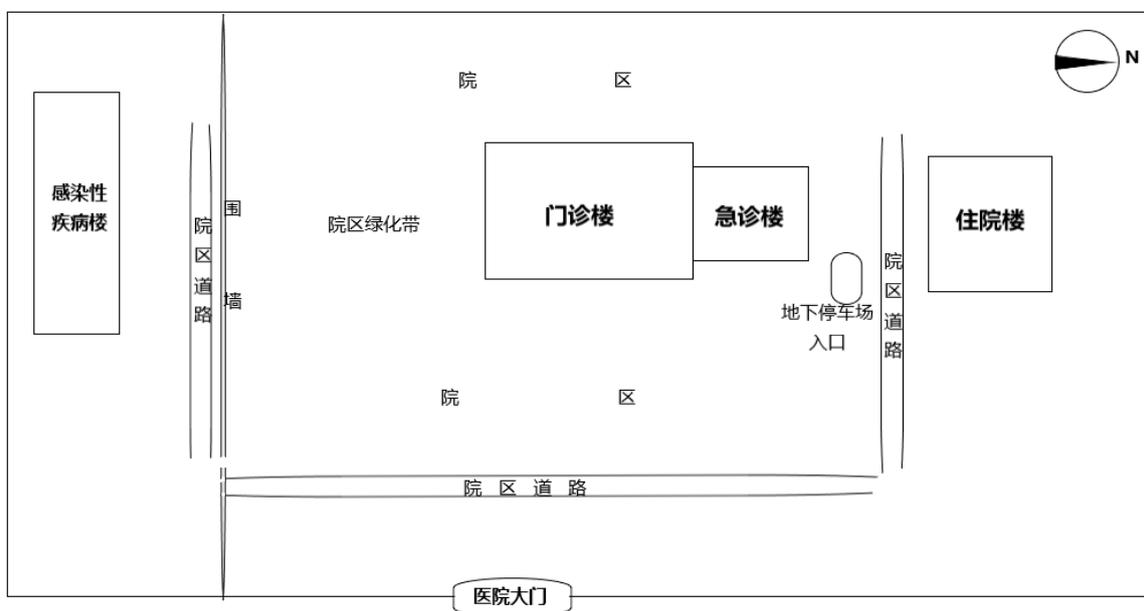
吴起县人民医院平面布置及四邻关系示意图
